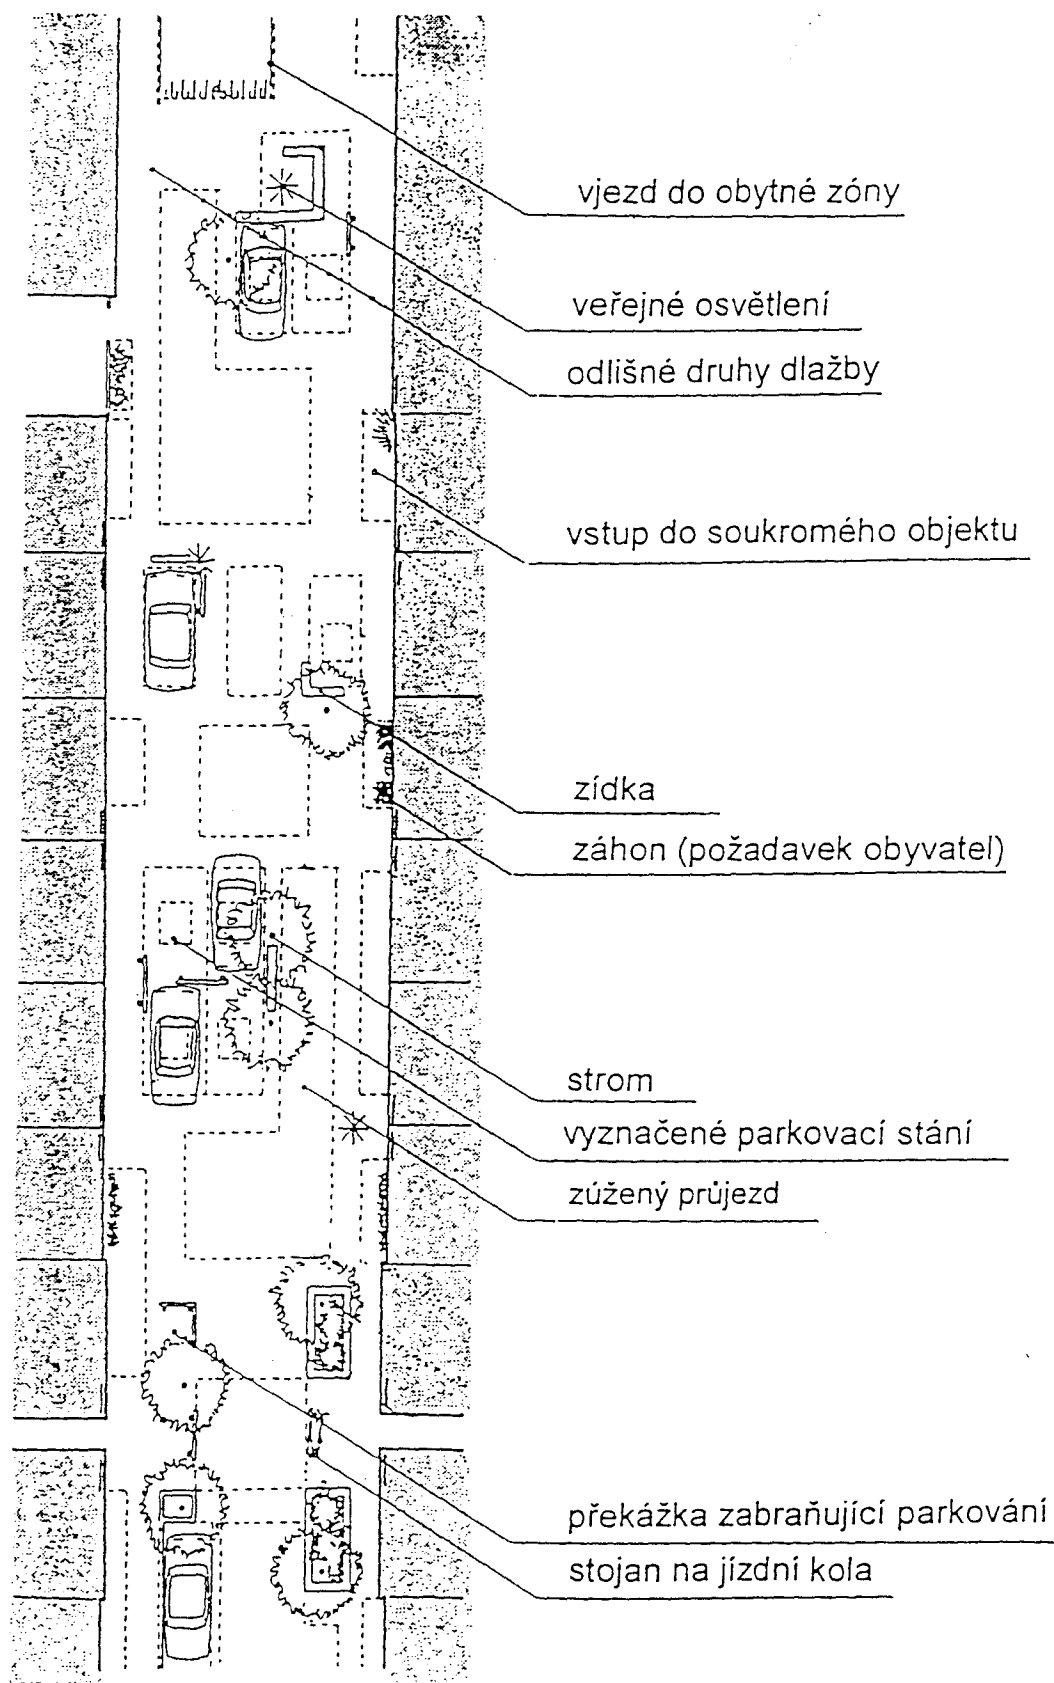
Příklad řešení příčného řezu obytné ulice v zástavbě městského typu (srovnej též s obr. 57)
